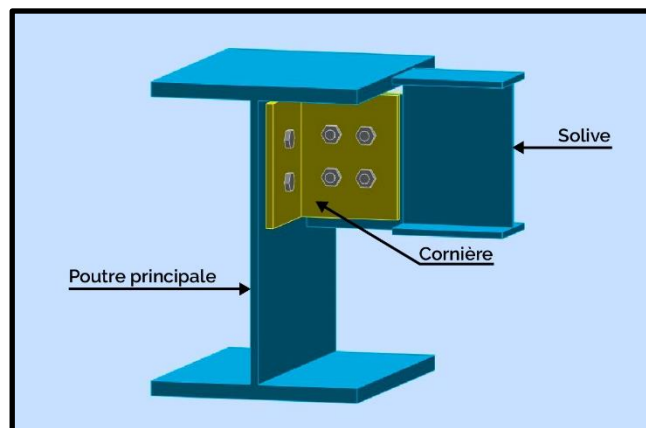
Assemblage poutre HEA 450 – solive IPE 220
